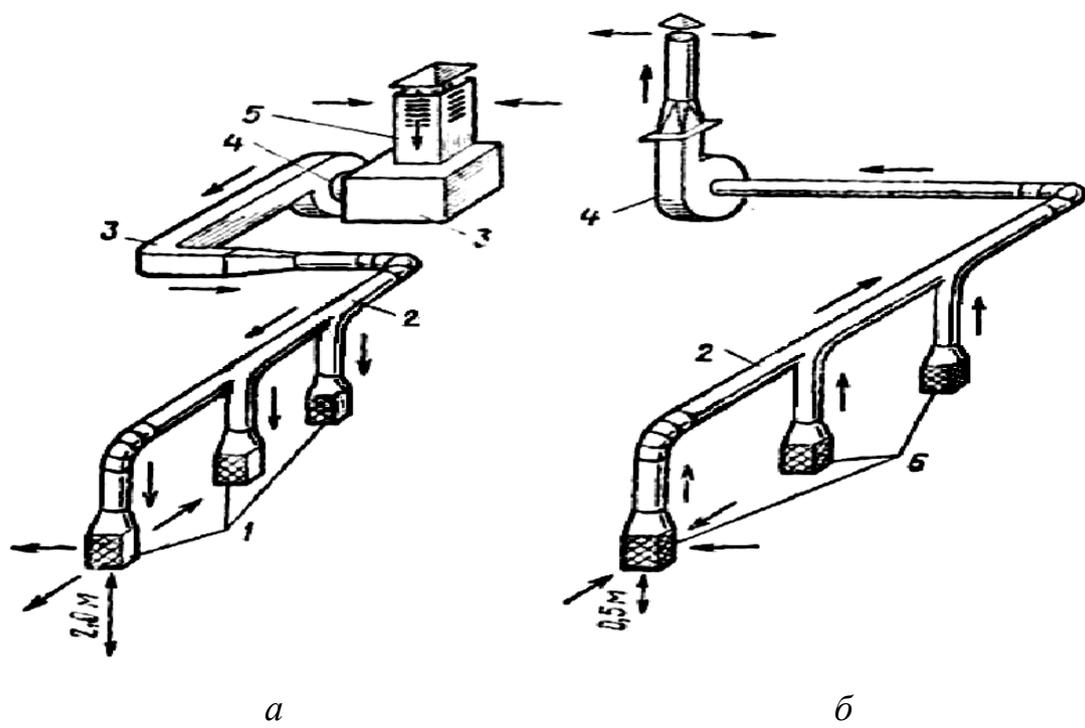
Схемы приточной и вытяжной систем вентиляции:
